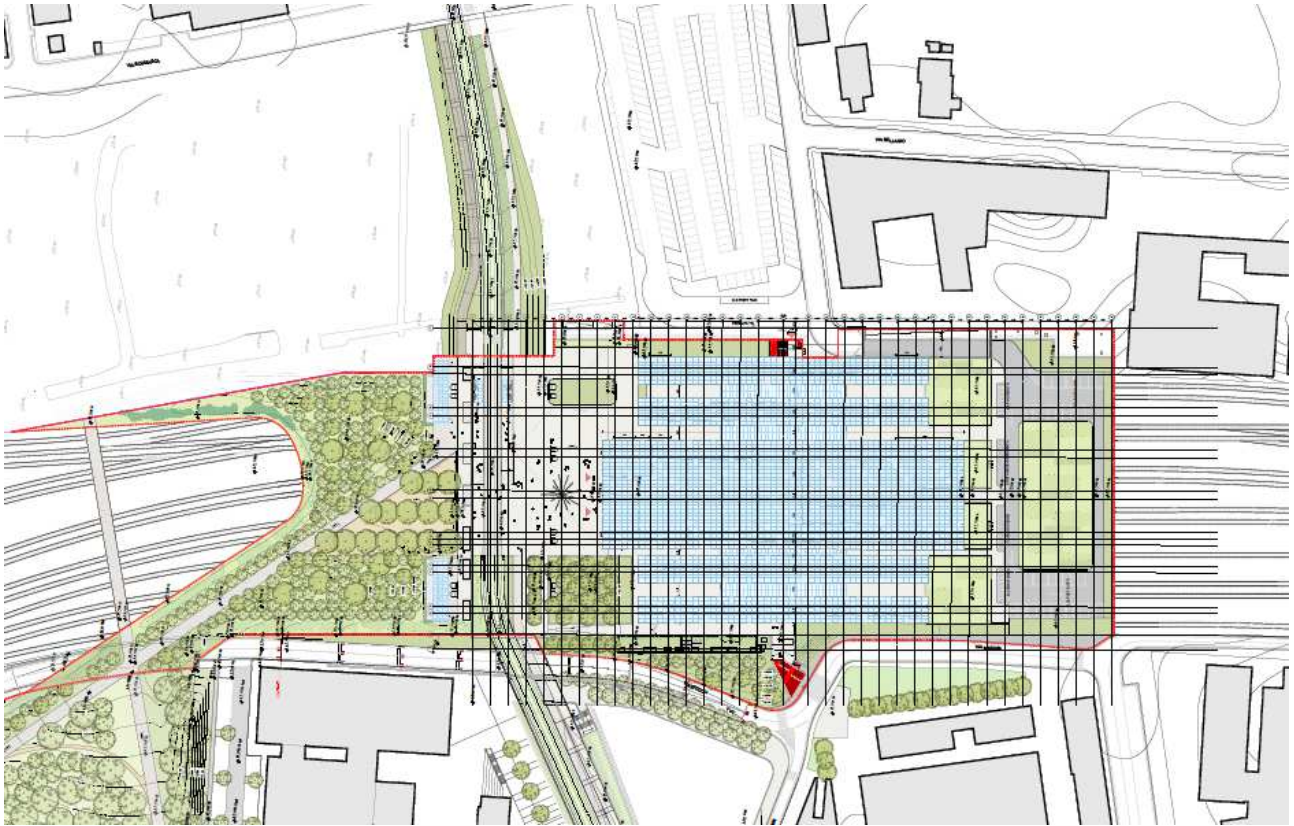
Individuazione interventi rampa accesso lato ovest di prima fase
